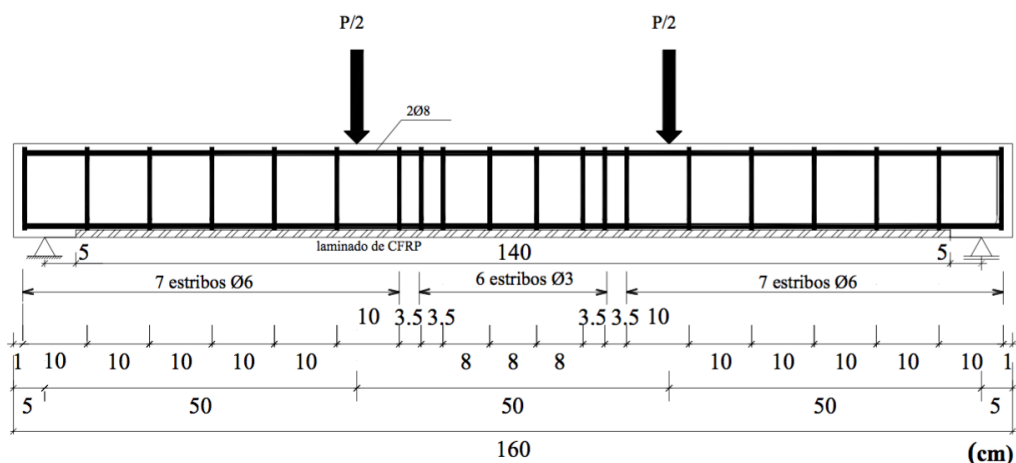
Detalhamento da seção longitudinal das vigas de FORTES *et al.* (2002)
